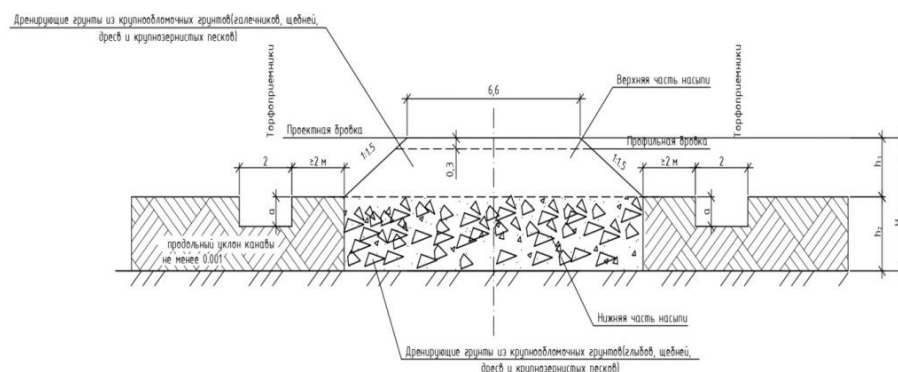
Поперечные профили насыпи ЖД линии на ПК1+80 до ПК7+80 (замена грунта)
